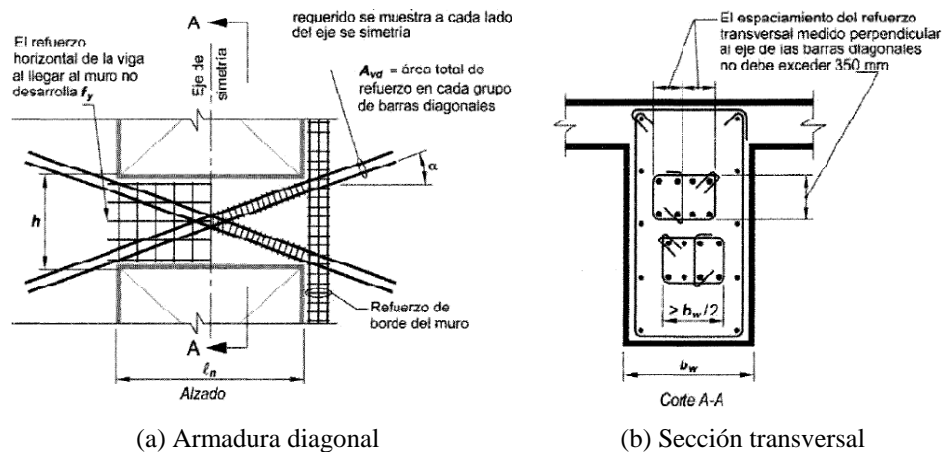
Detalle del armado recomendado en vigas de acoplamiento [ACI-318, 2008]
